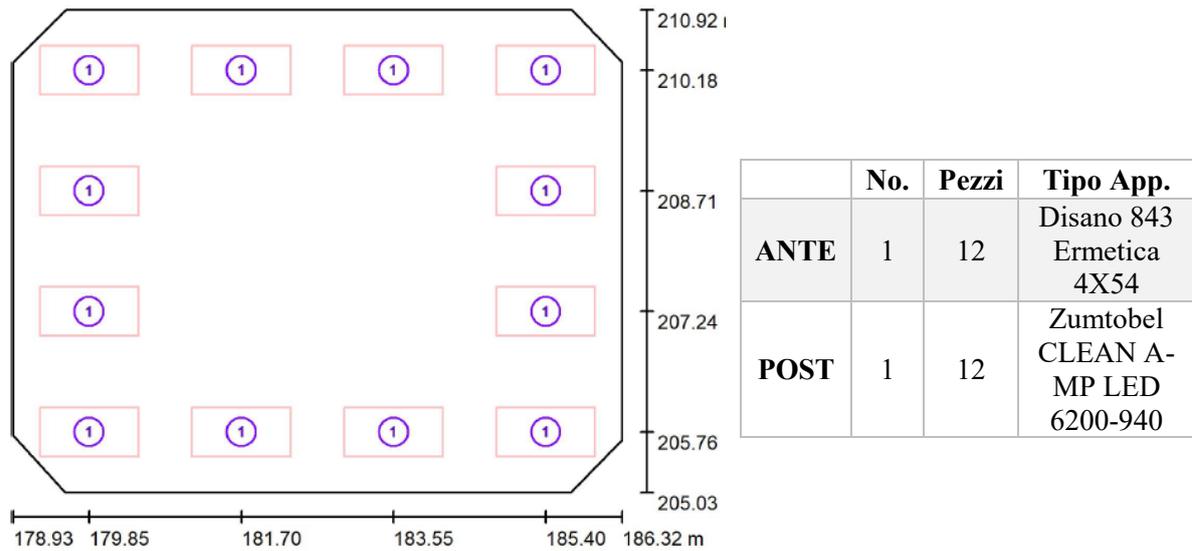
Disposizione in pianta degli apparecchi di illuminazione.
